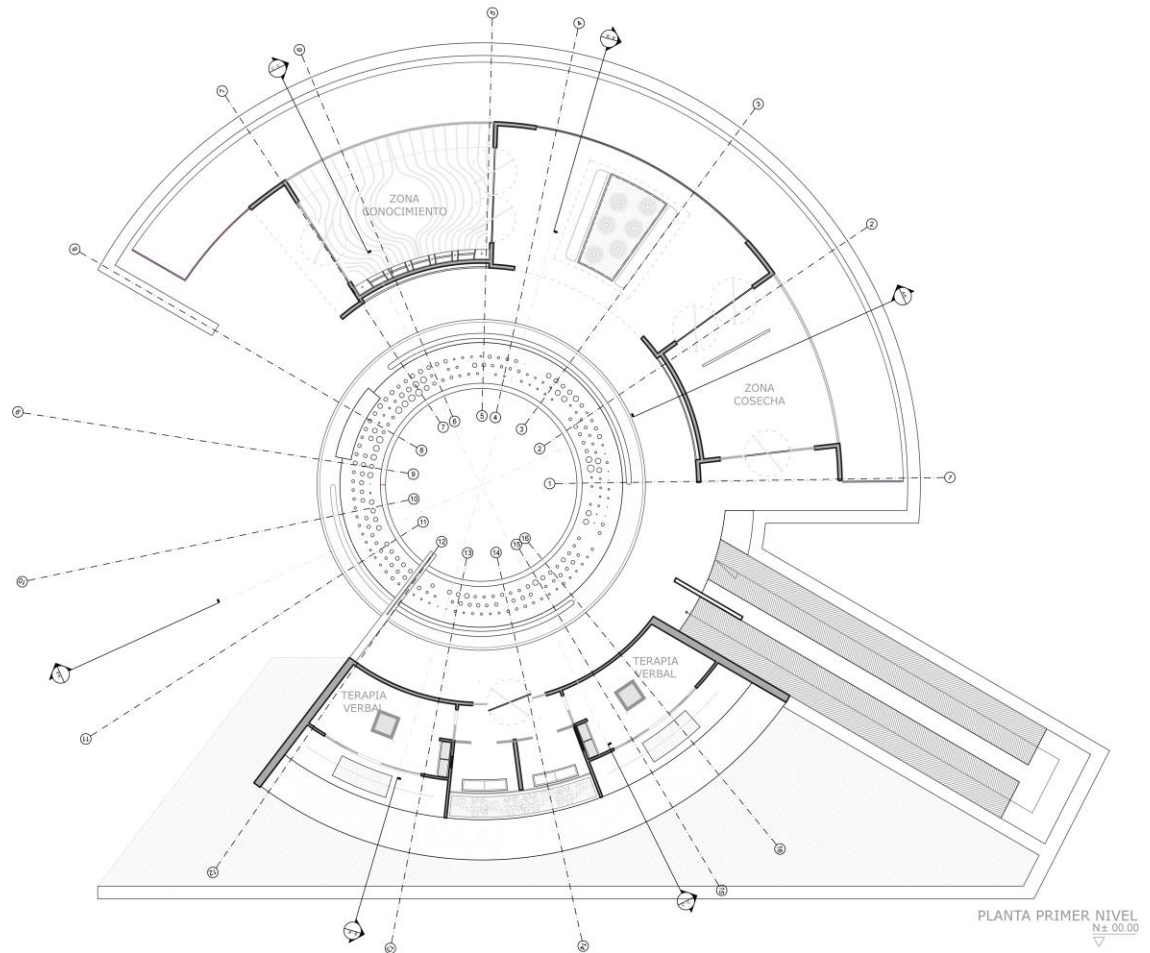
Planta Arquitectónica Nivel 00.00. Esquema realizado por la autora
